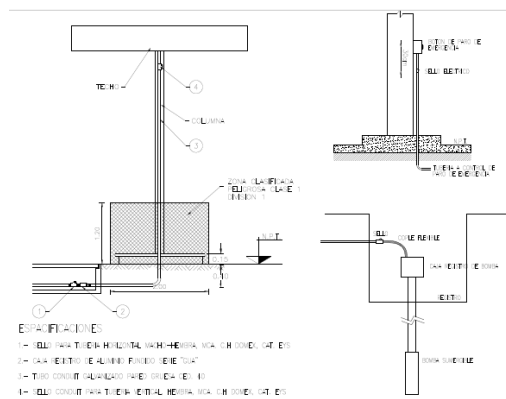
Detalle de conexión en registro para bomba sumergible.
